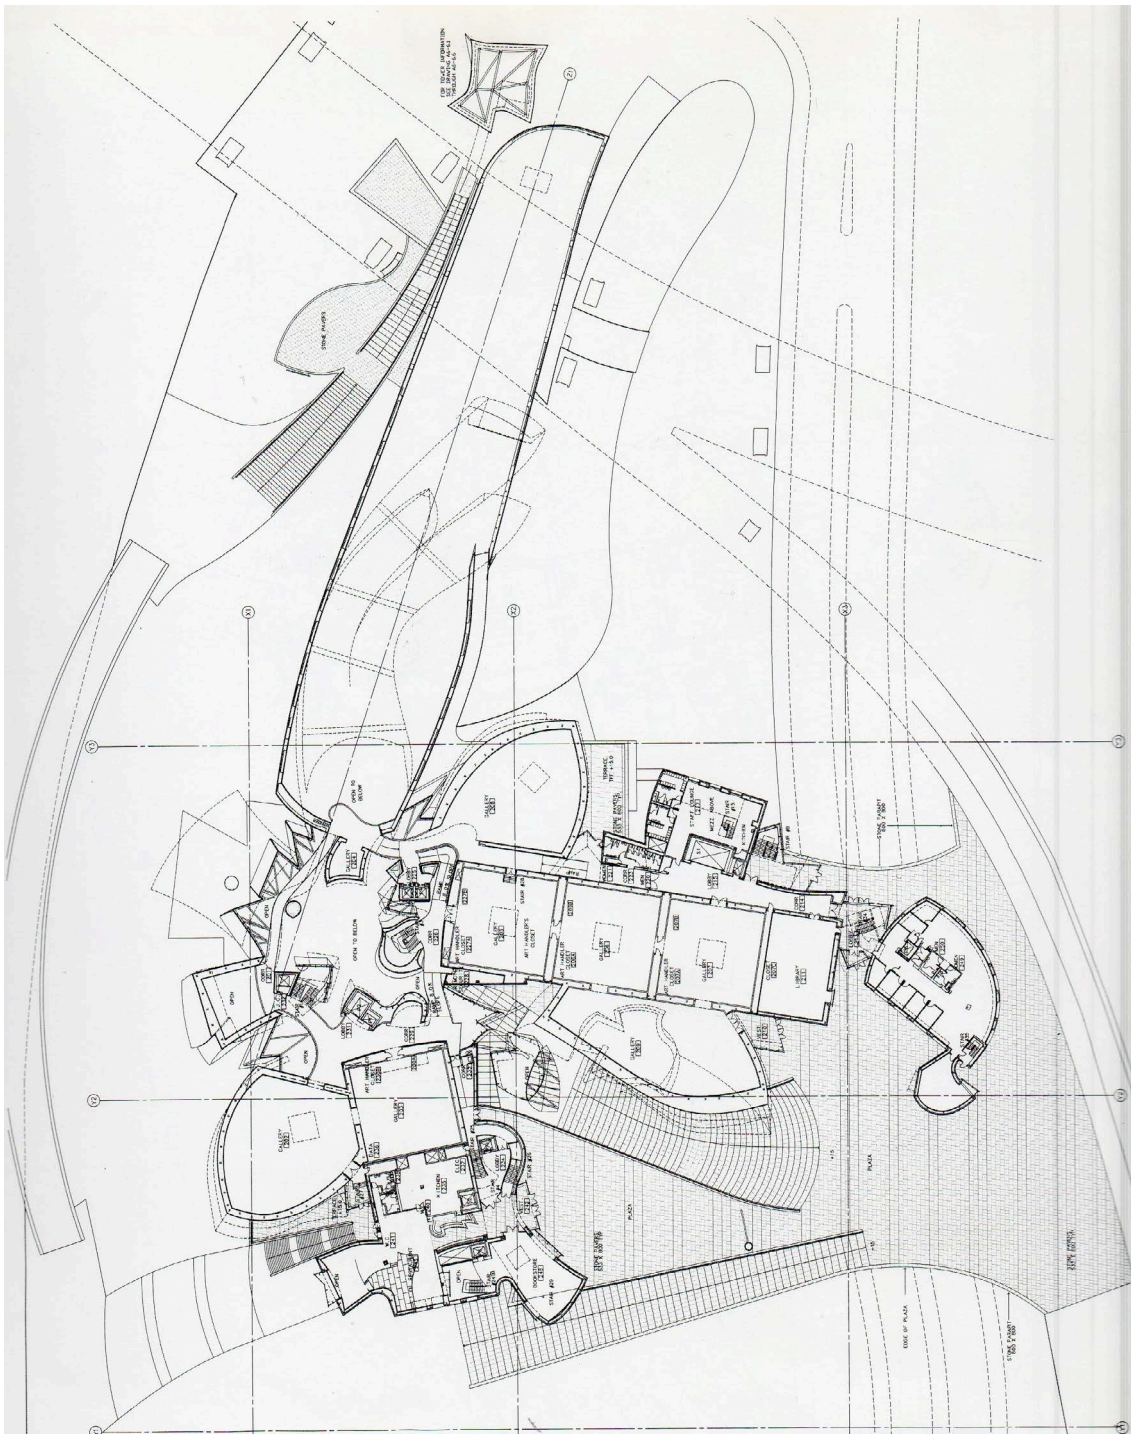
Frank Gehry, Ausführplan Guggenheim Museum, Grundriss 2. Geschöß, Straßenniveau
